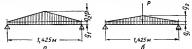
Расчетная схема поперечного ребра и схемы нагрузок при действии: постоянной и снеговой нагрузки. 6 — постоянной и сосредоточенной нагрузки.
